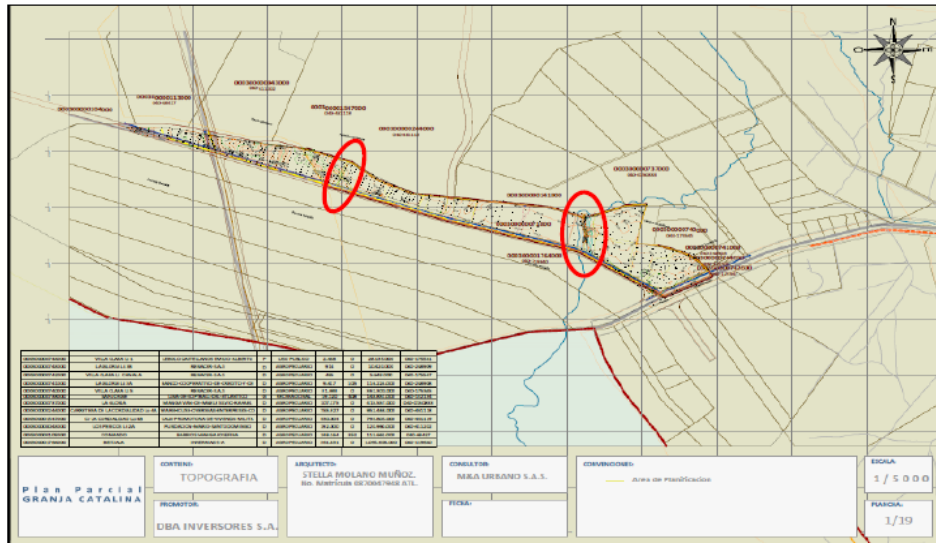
Planteamiento Plan Parcial Granja Catalina
